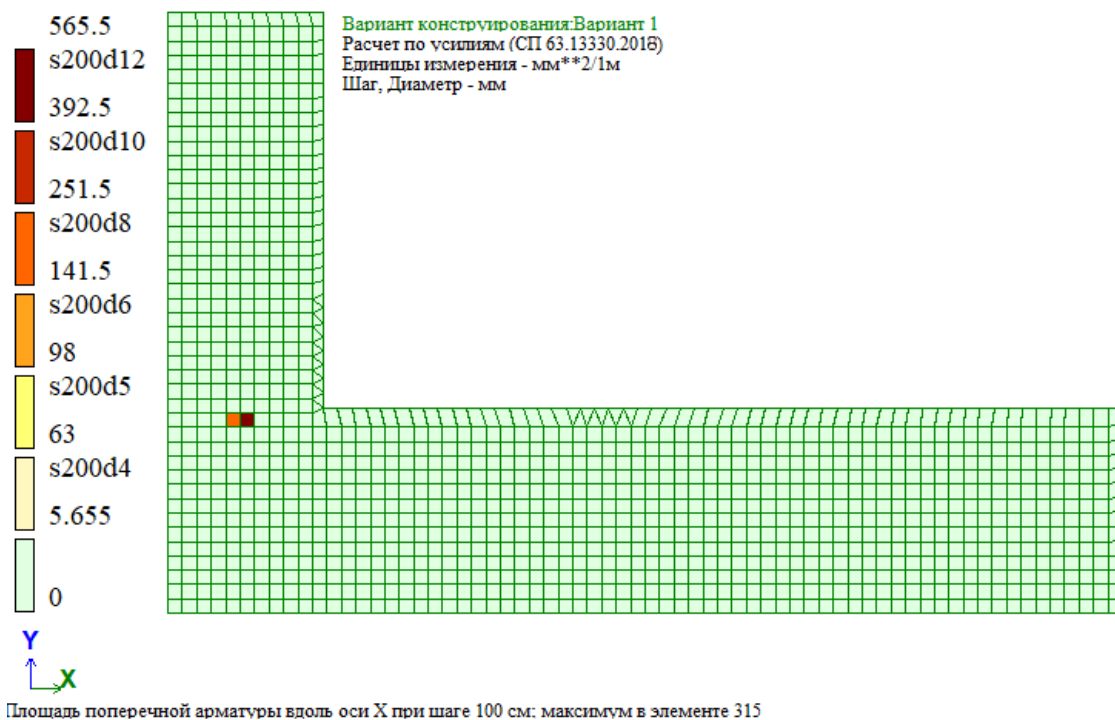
Подбор поперечной арматуры по оси X
